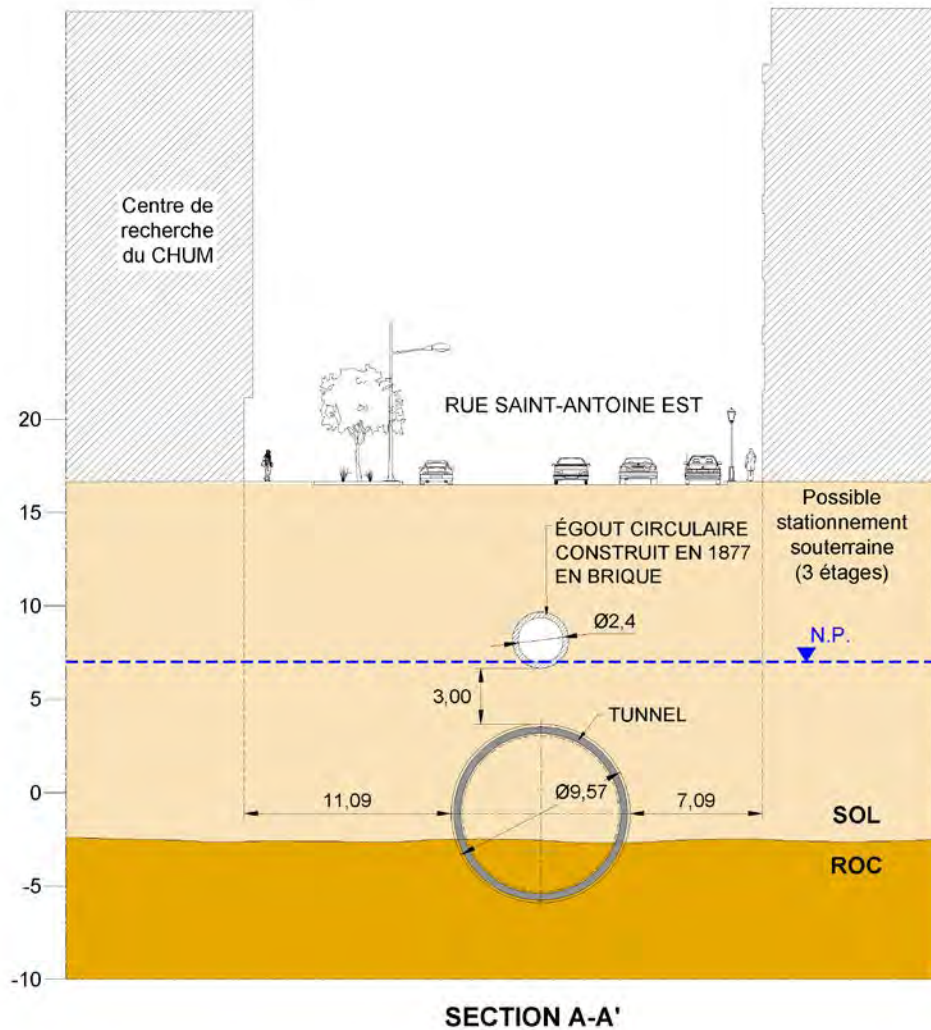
b. Section transversale du corridor Saint-Antoine au chaînage 1+348.
